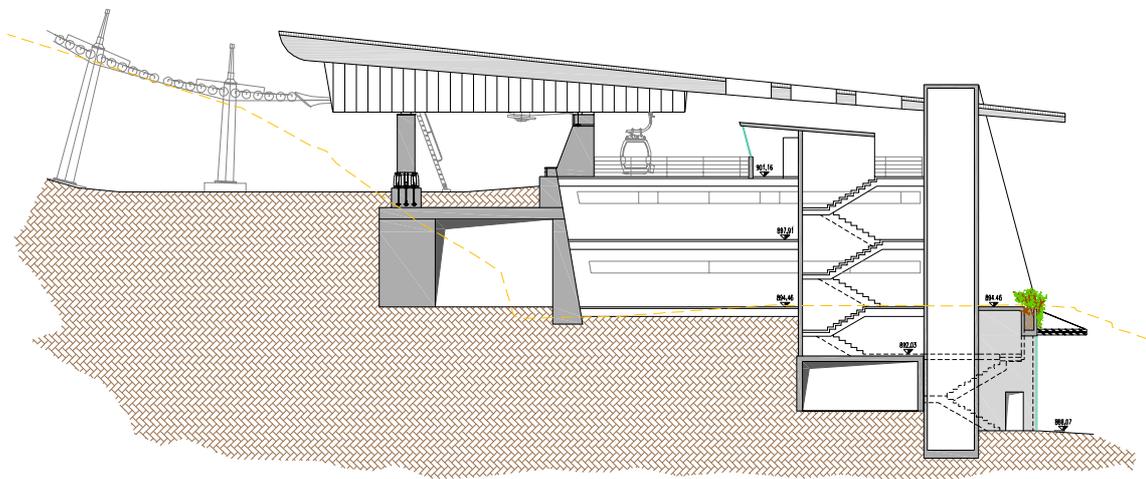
sezione della stazione di valle del nuovo impianto di risalita Molveno-Pradel
